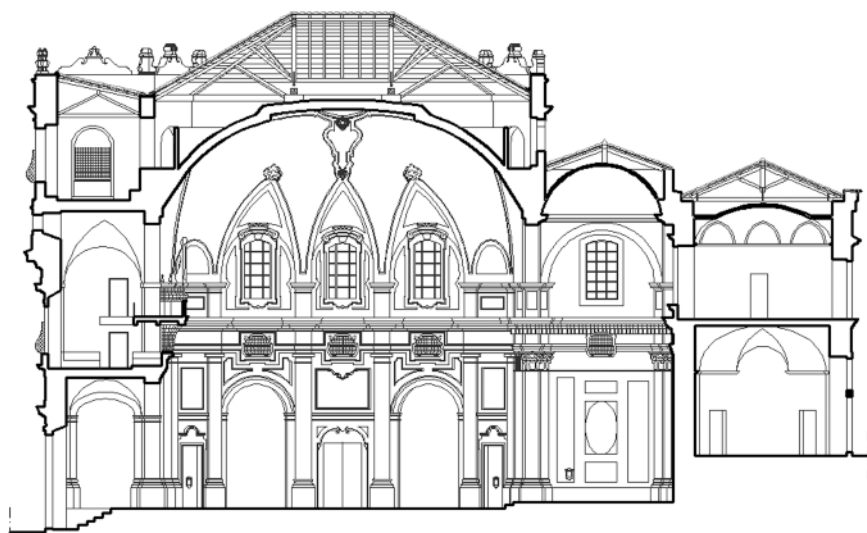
Sezione longitudinale della chiesa di S. Chiara (CT).
